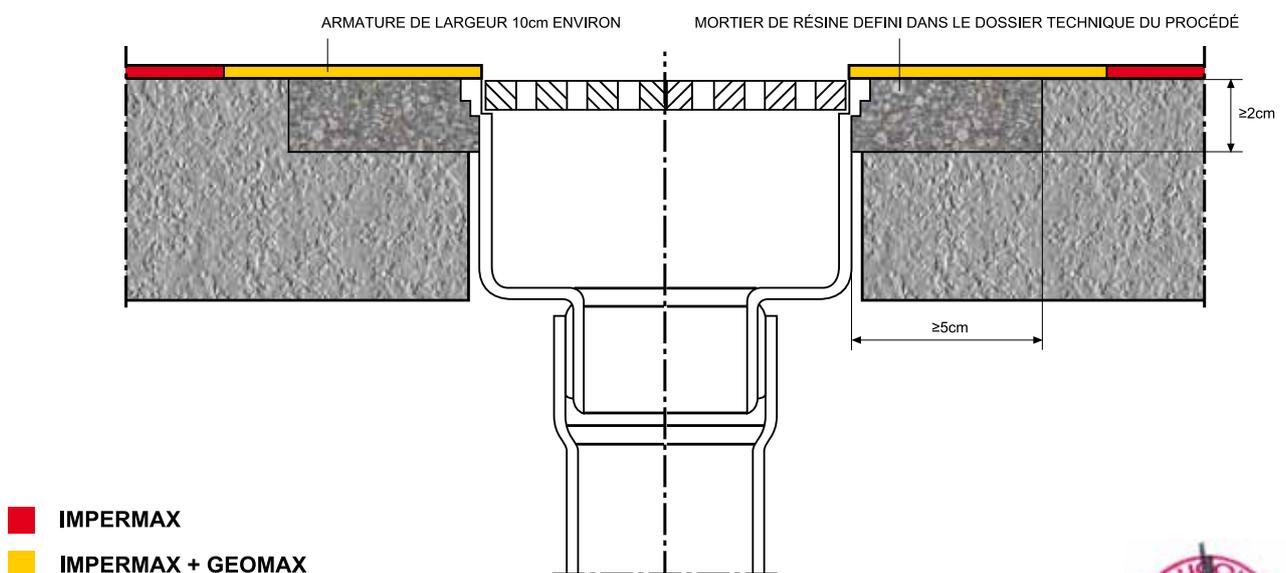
Traversée d'une canalisation avec platine et manchon métallique
